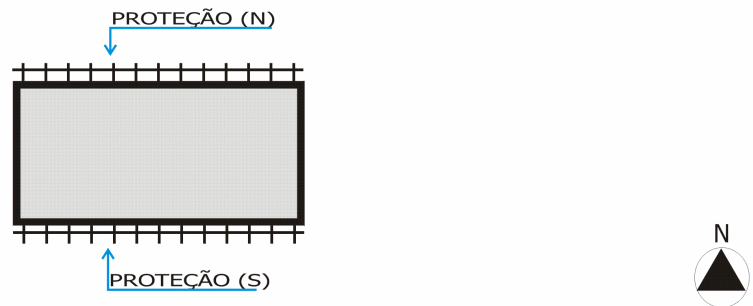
Fachadas nas quais os dispositivos de proteção solar misto são mais indicados.
